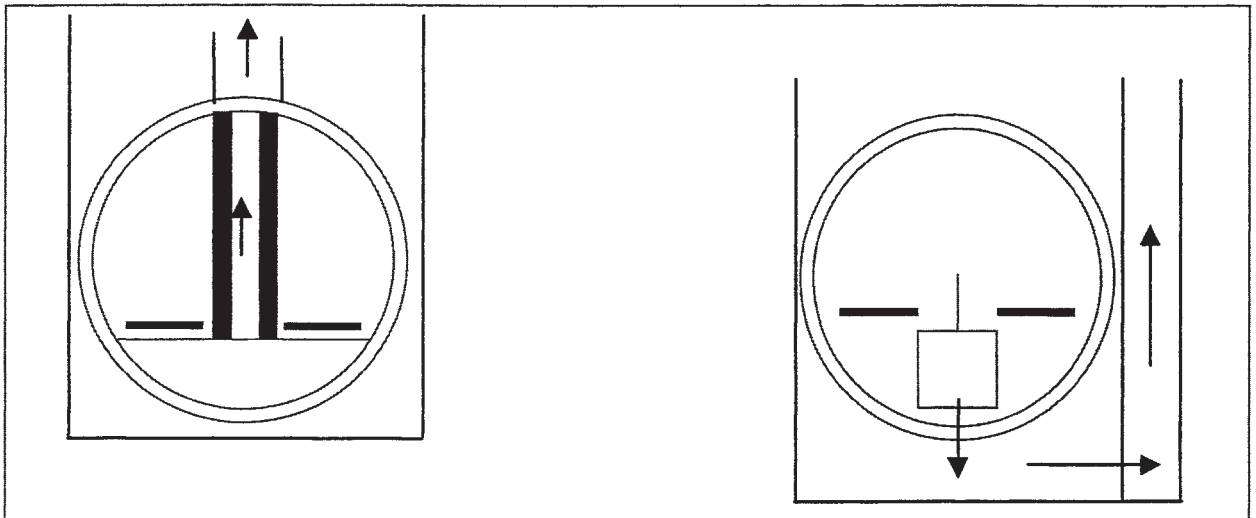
, Alternatief 1 en 2, Dubbelsporige tunnel met tussenwand en met twee vluchttunnels
